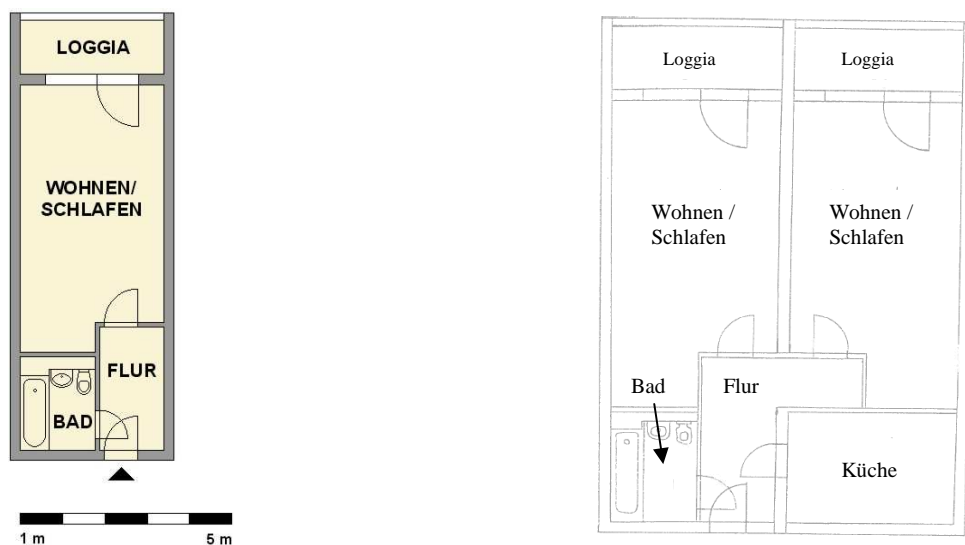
Grundrissänderungen für die 2-Raum-Wohngemeinschaft
